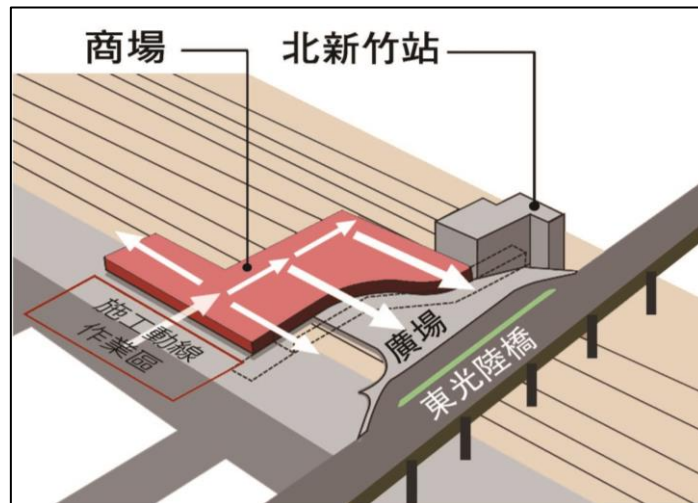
北新竹車站第一期工程施工順序示意圖
